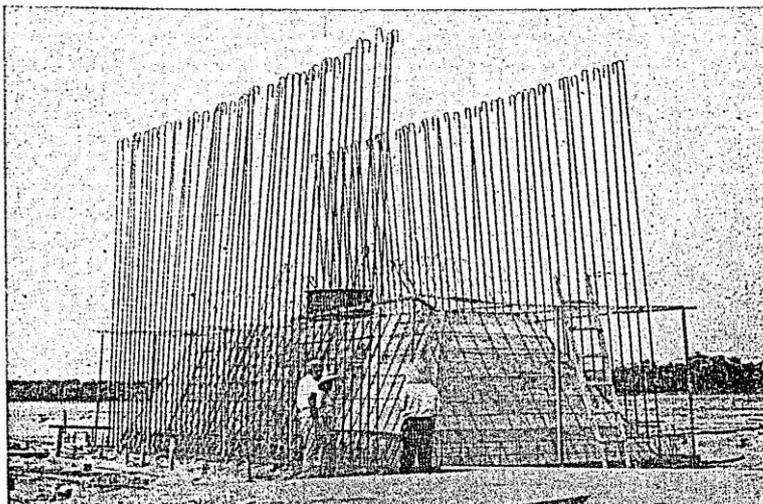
Detalhe da armação dos pilares da Ponte Rio Grande.
